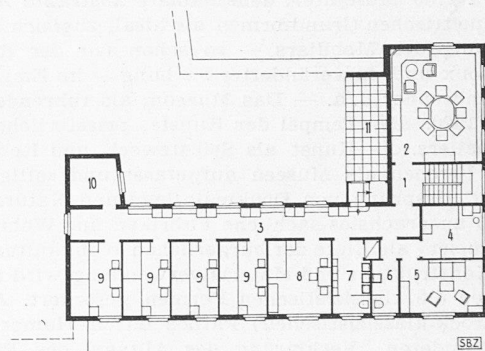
Grundriss des Obergeschosses, 1:400.
